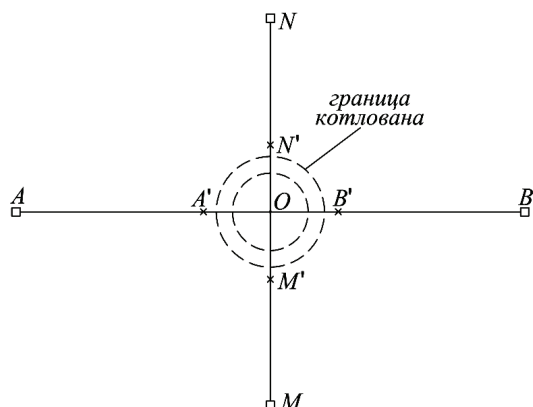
Схема расположения разбивочных осей строящейся дымовой трубы.
